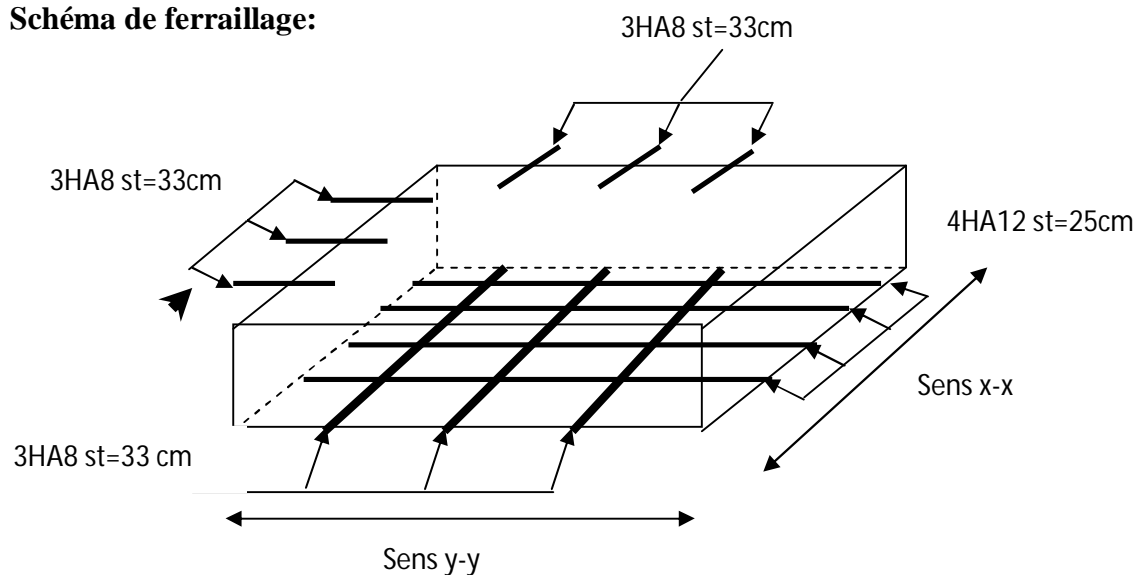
Schéma de ferrailage d'une dalle sur3appuis
